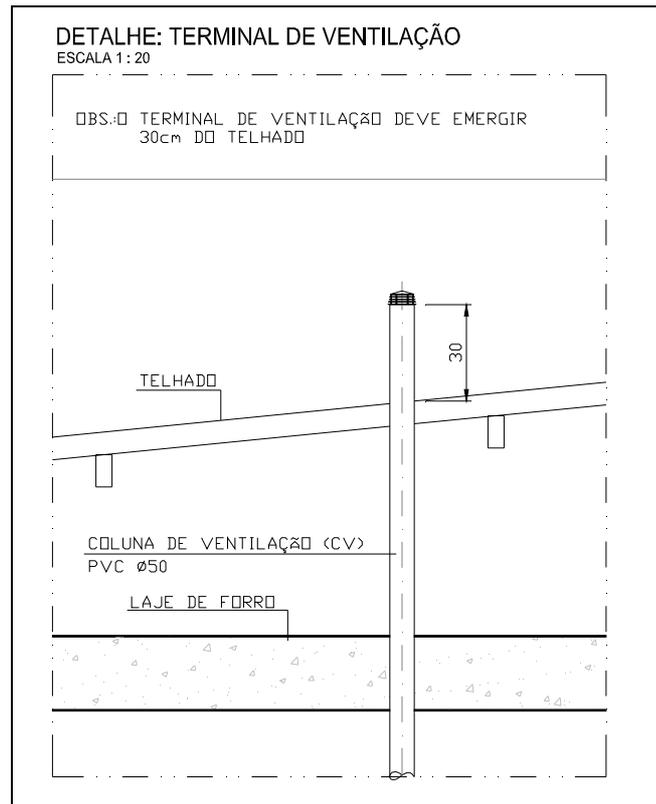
Detalhamento do terminal de ventilação (Projeto A)
